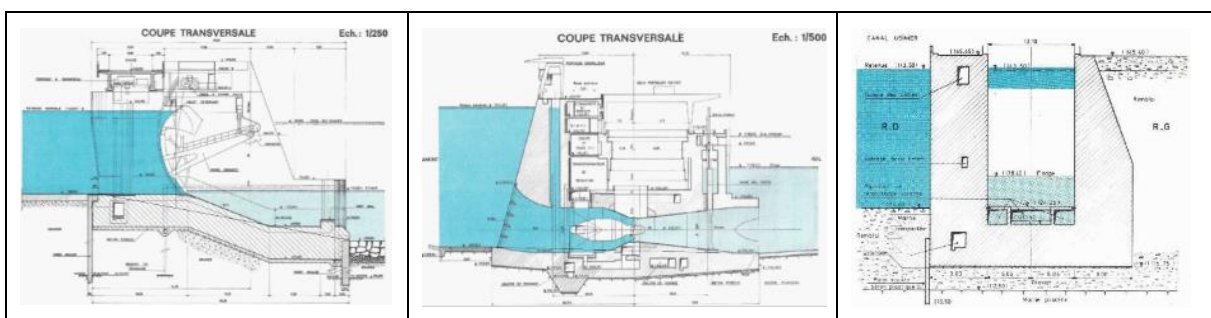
Coupe transversale d'un barrage mobile, d'une usine et d'une écluse CNR
